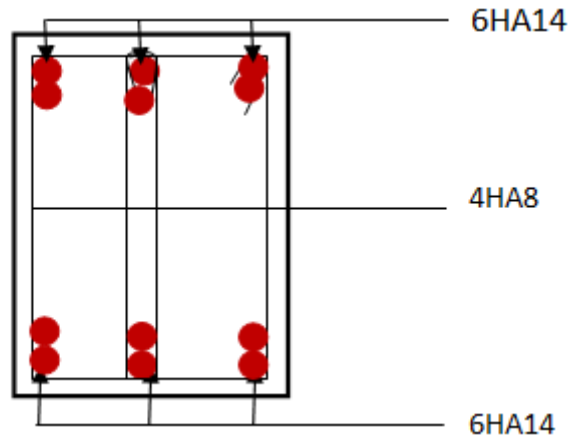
Ferrailage en travée d'une poutre principale.
